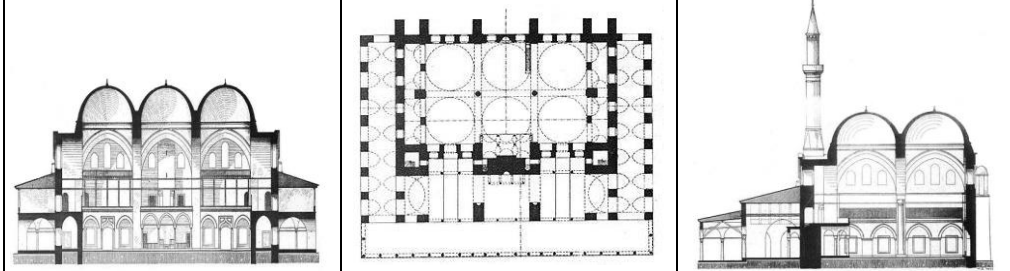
مسقط أفقي لجامع صوقللو مجد عند باب العزب في إستانيول يوضح سقيفته ذات السقف المائل. (عن: كوران بتصرف).
